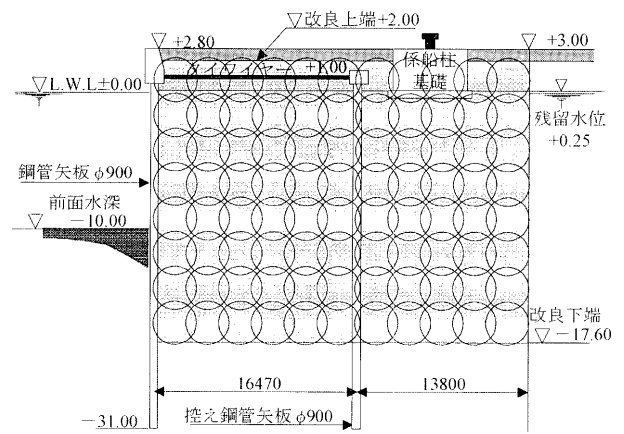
(b) 施工断面図 (A 部) (石狩湾新港)
